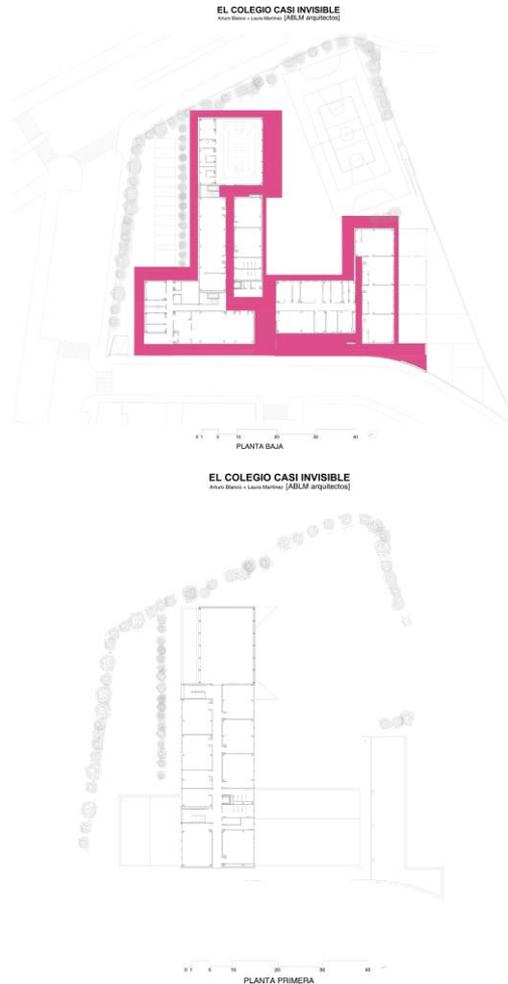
Plantas arquitectónicas (primera y segunda) del proyecto.
